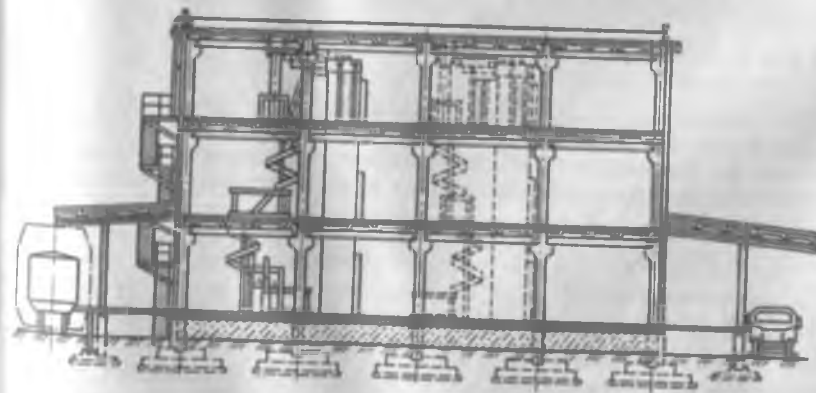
Склад из сборного железобетона для хранения муки в таре
